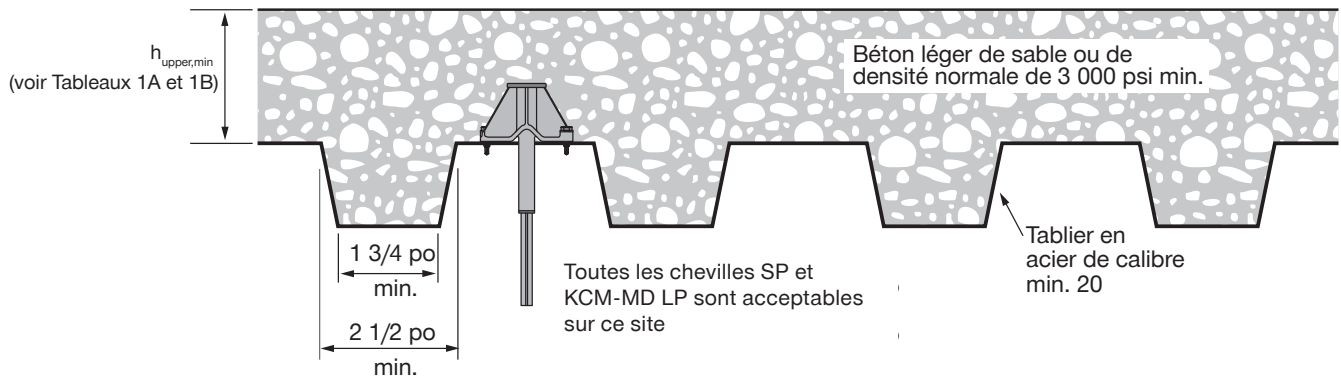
A – Installation dans le soffite d'un plancher ou d'un toit en béton sur tablier métallique sur la cannelure supérieure (tablier « B » et tablier « W »)
